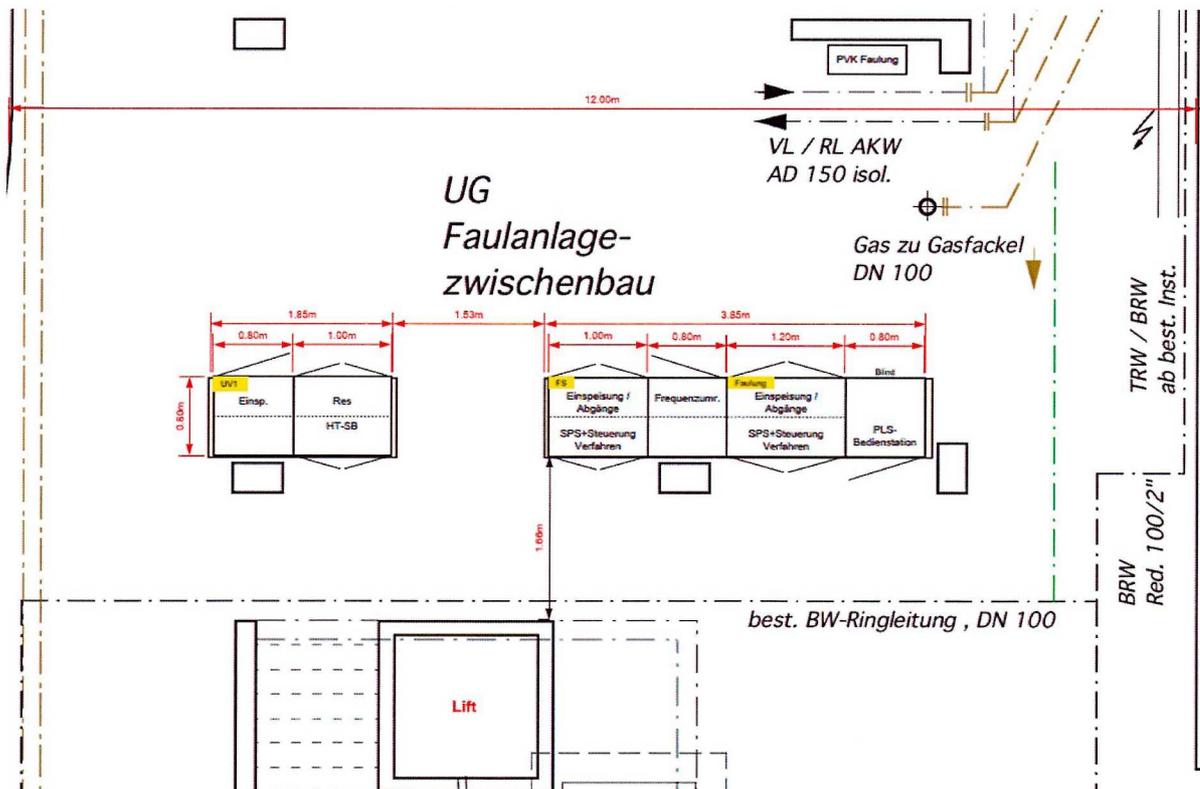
Grundriss Faulanlage-Zwischenbau UG bestehend
